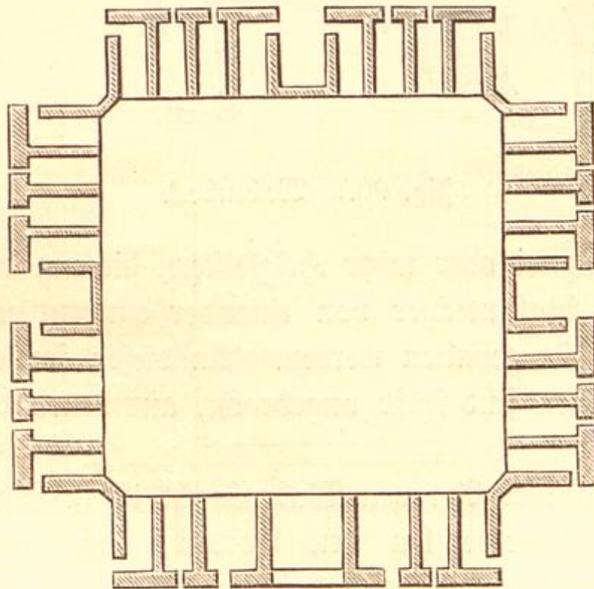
Grundriß des 28 fährigen Pavillons.
